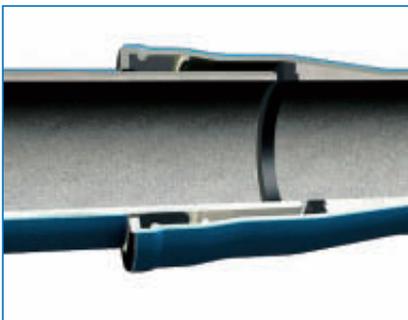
Stahlsteckmuffenverbindung für Betriebsdrücke bis 40 bar
